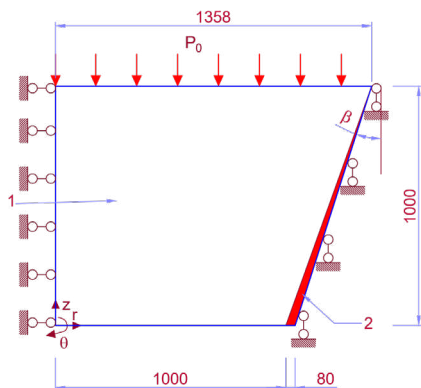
Расчетная схема ¼ ТЭ со шпонками КВД: 1 – бетон В40; 2 – слой армирования
